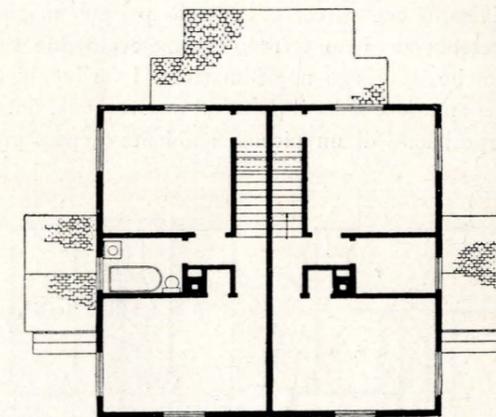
Pianta del primo piano di una casetta costruita dalla « Ludlow Manufacturing Associates ».
